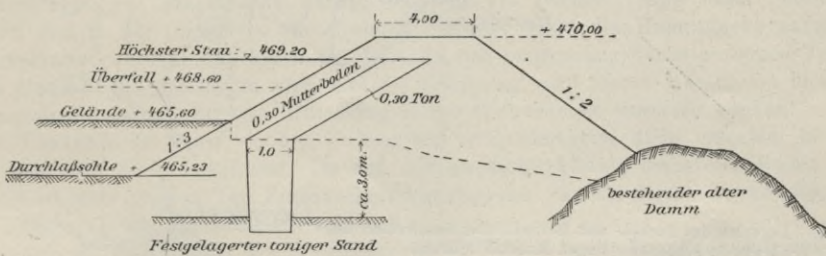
u. 165. Querschnitt der Staudämme von Grüssau (Schlesien).
